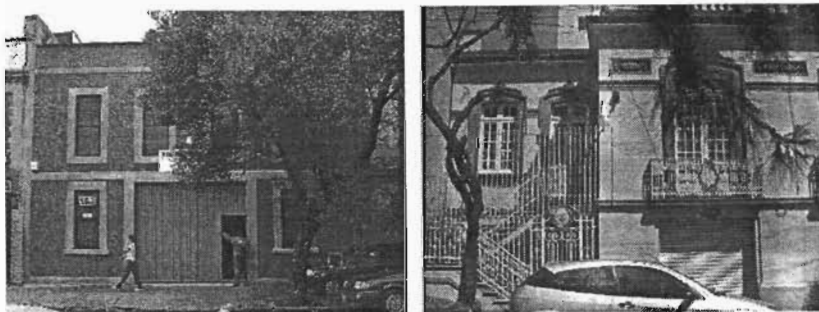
Mampostería con refuerzo y ladrillo sólido
